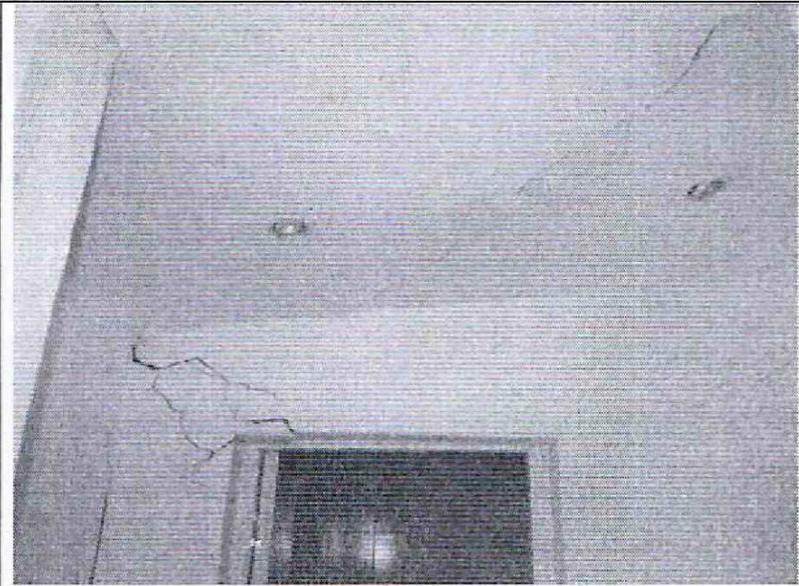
Grietas y deformación en muros y cielo raso.
